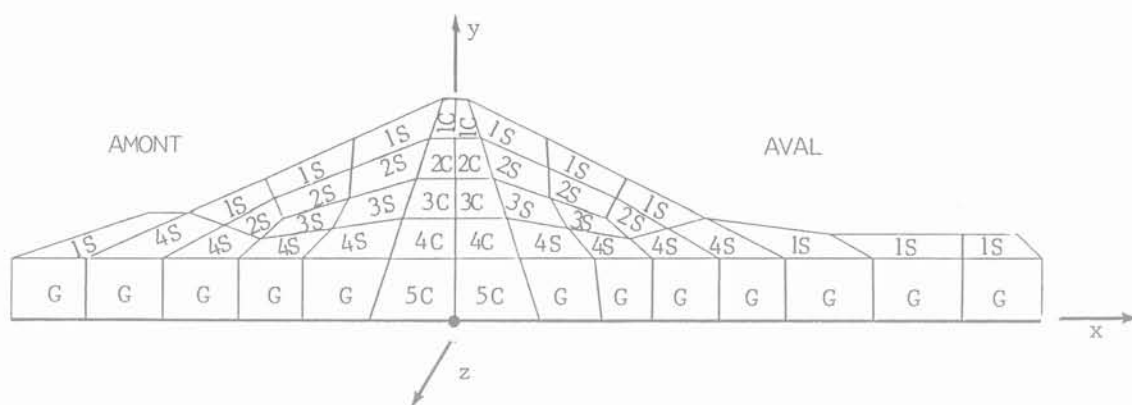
Le barrage en terre de Santa-Felicia : Détails structuraux.
